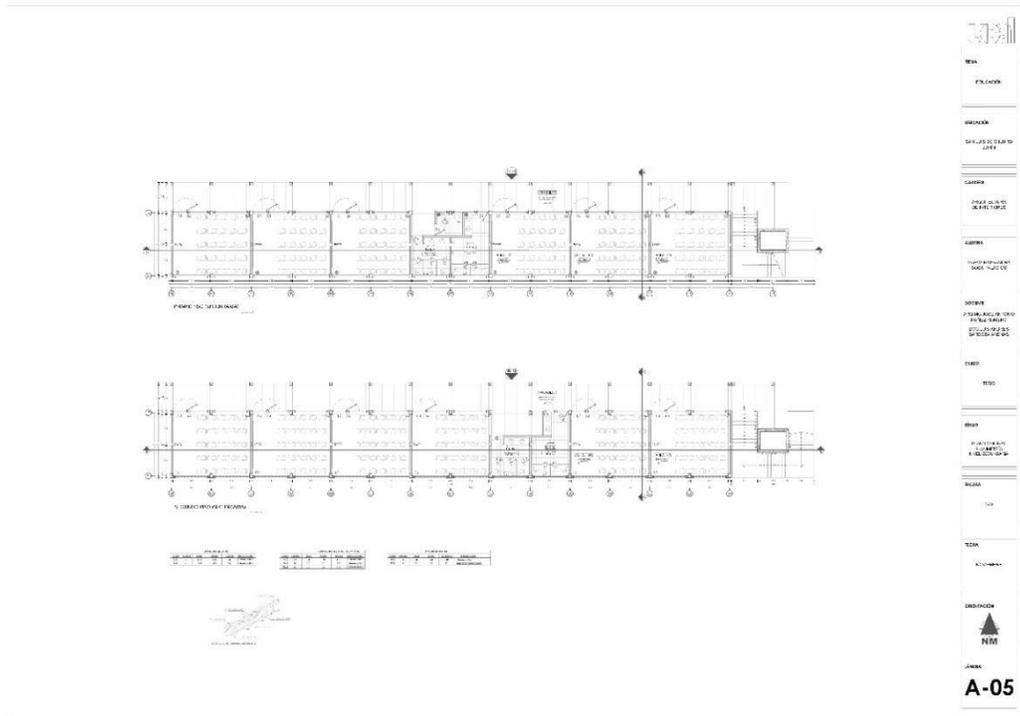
Planimetría Existente de la Municipalidad de San Luis de Shuaro. *Fuente:* Maeva Sosa
